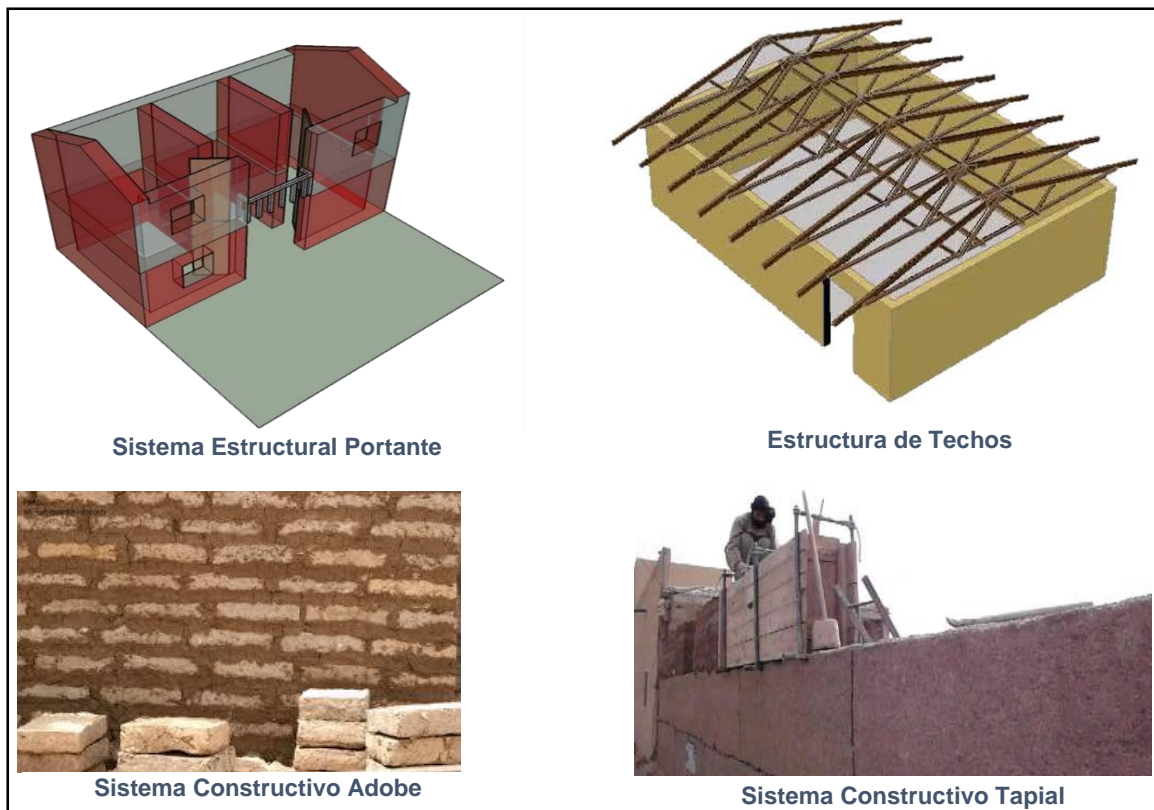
Patrones Estructurales y Constructivos (Primer Cuartel)
